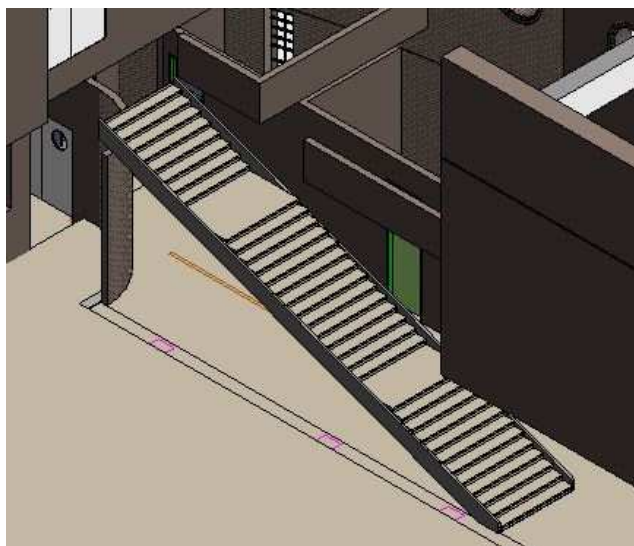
Visualización 3D escalera acceso planta inferior (II).
